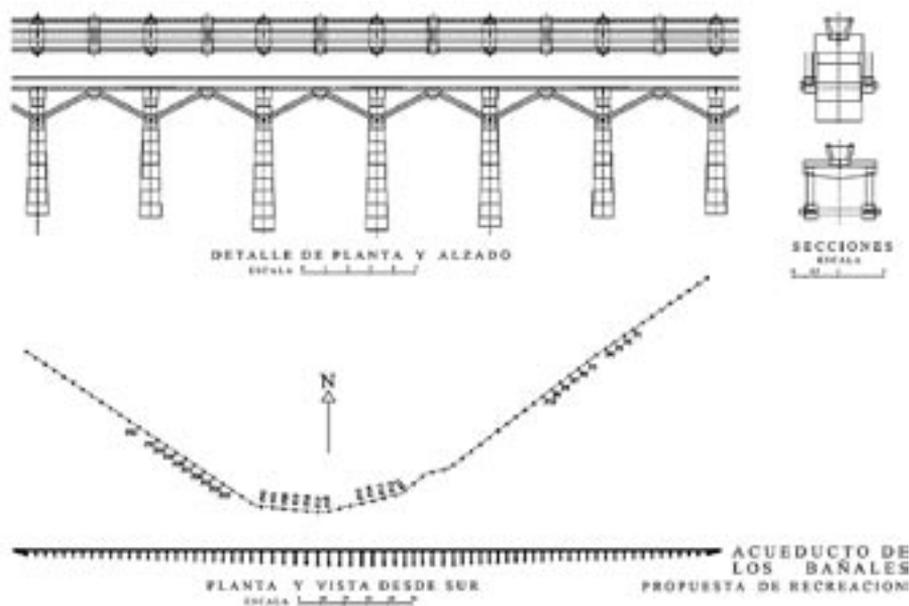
Plano de la propuesta estructural para el acueducto de Los Bañales.
